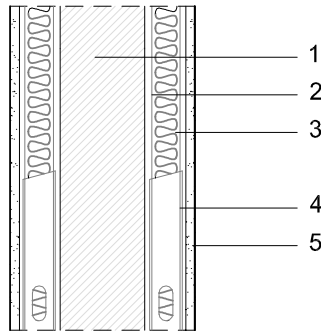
Ejemplo de elemento de separación de tipo 1. Elemento base de fábrica, trasdosado por ambos lados con 2 placas de yeso laminado ancladas a una perfilería metálica autoportante.
